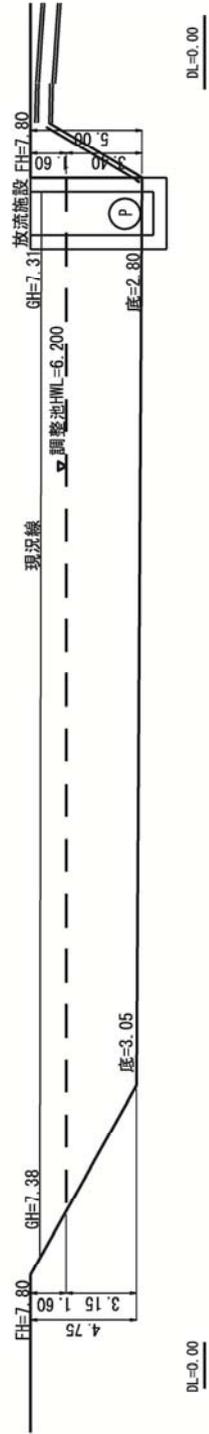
(2) 調整池計画平面・断面図 (第3調整池) 【変更後】
